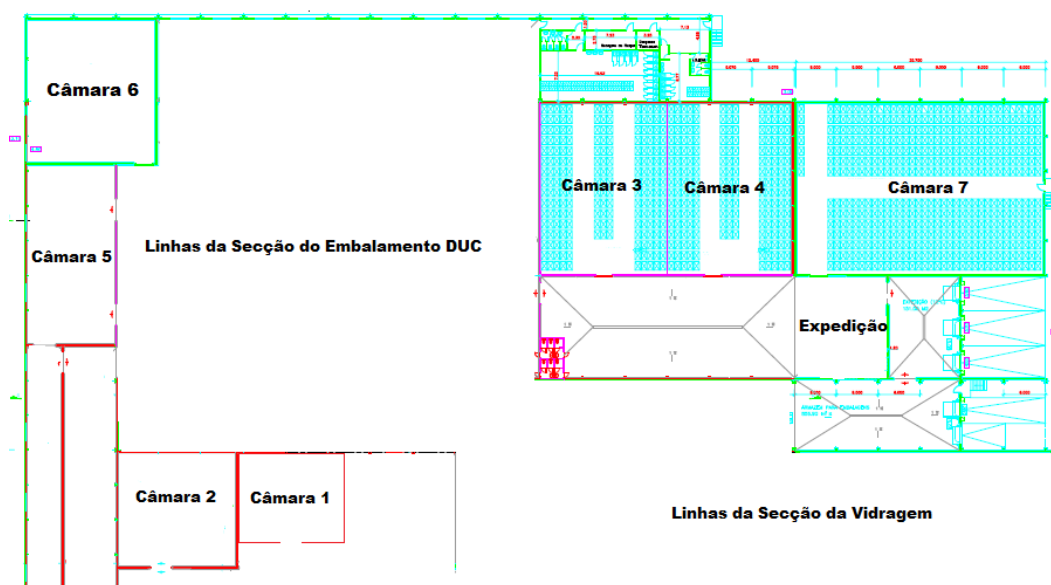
Layout das câmaras de produto congelado e produto acabado.
